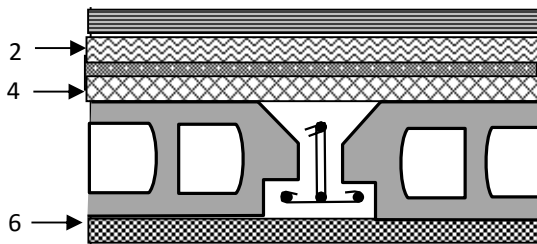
Coupe transversale dans Le plancher terrasse inaccessible.
